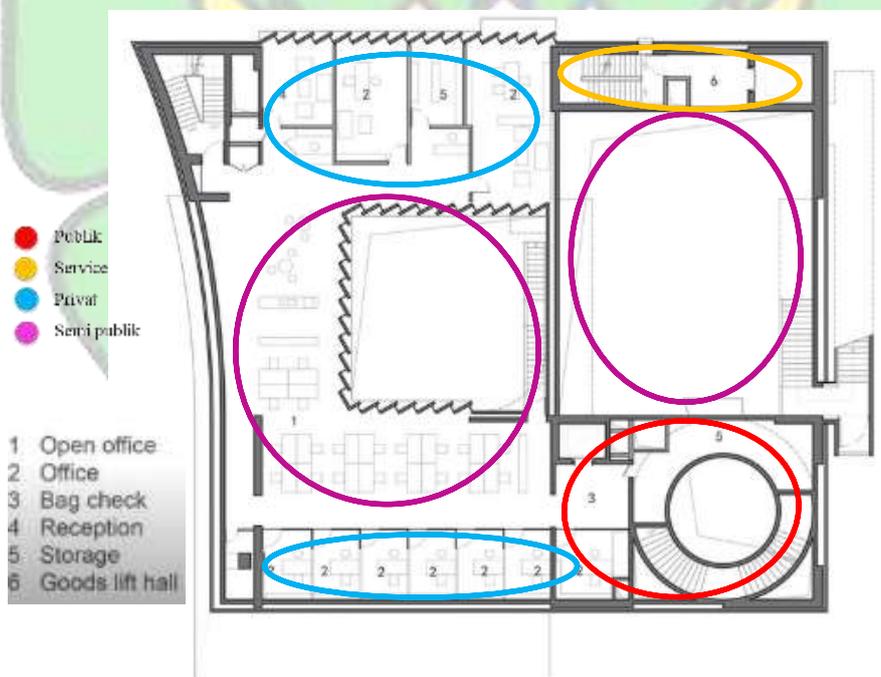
Denah Lantai 1 Bangunan Gallery Taiyuan, China
